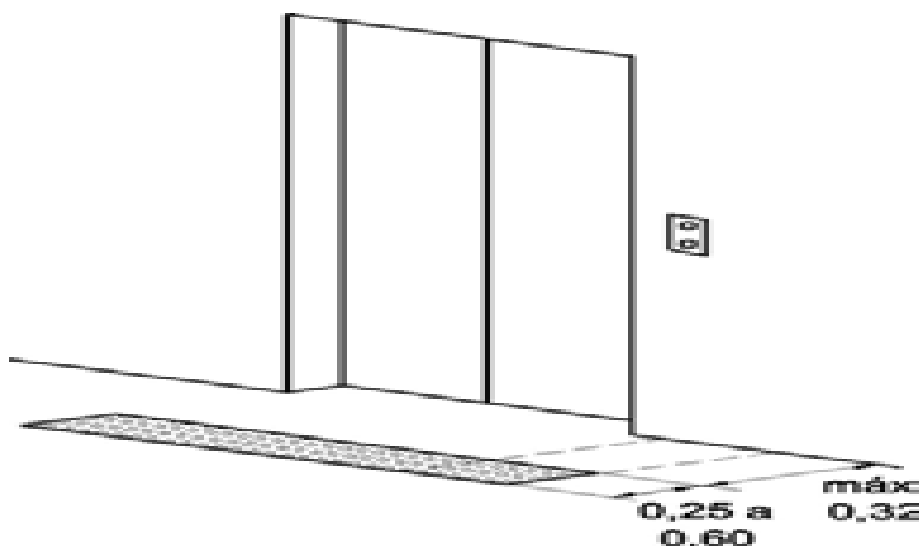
Sinalização tátil de alerta junto à porta do elevador
